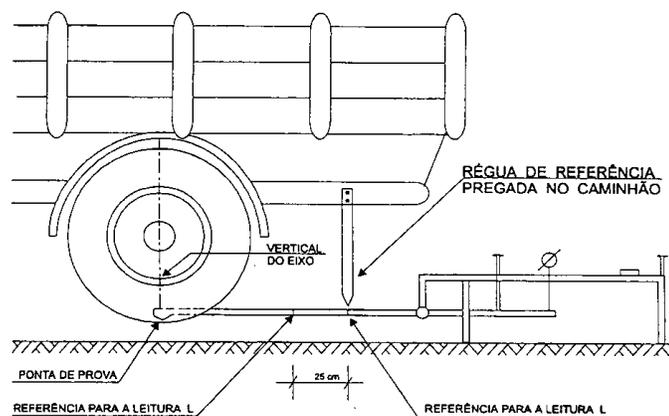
Posicionamento da Viga Benkelman e da ponta da prova de carga
